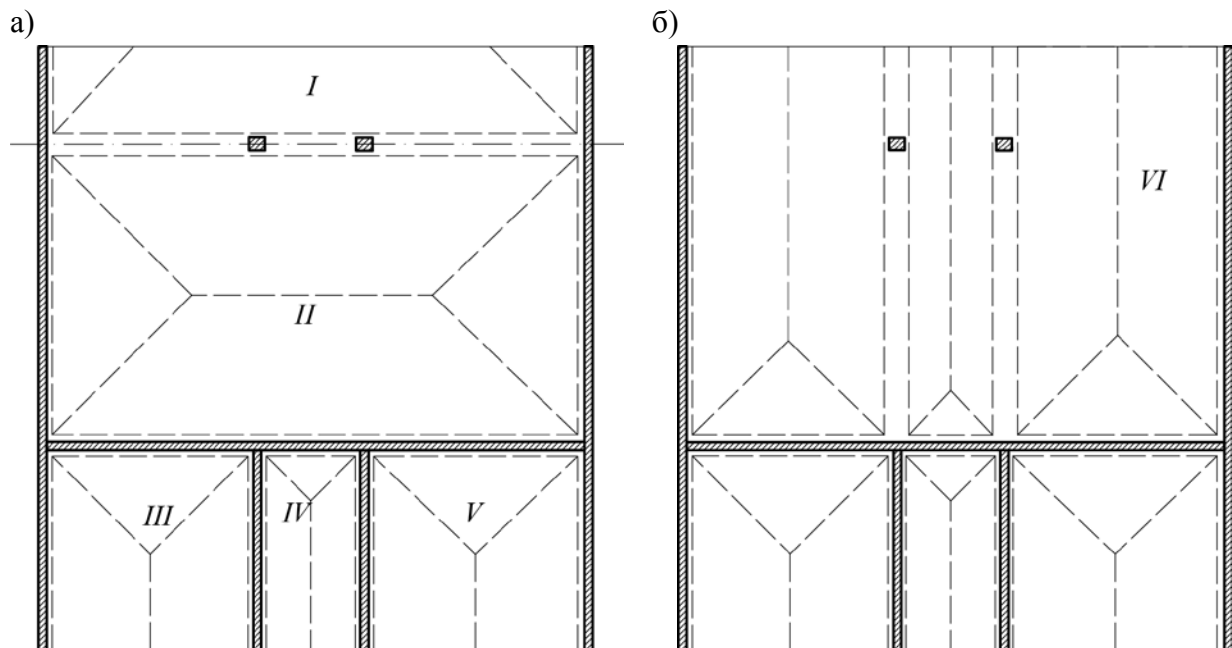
Механизмы разрушения плиты перекрытия
